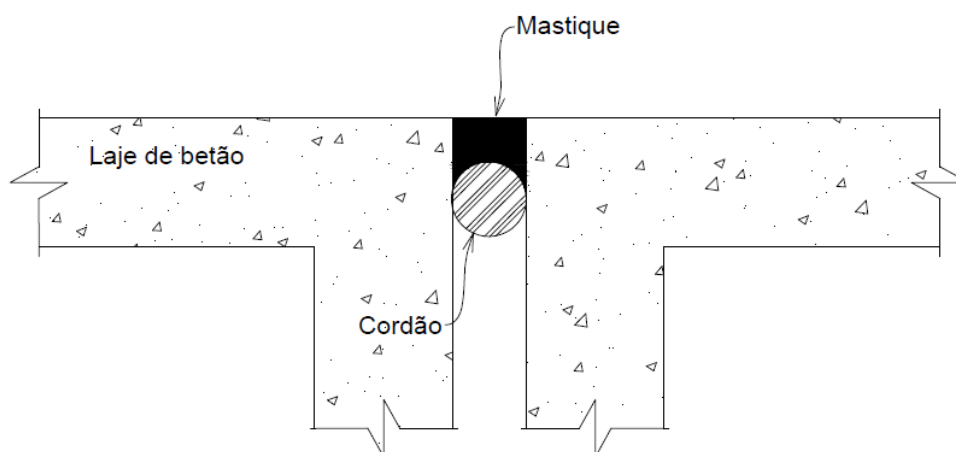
Selagem de junta de dilatação (Fonte: Desenhado pela autora)
